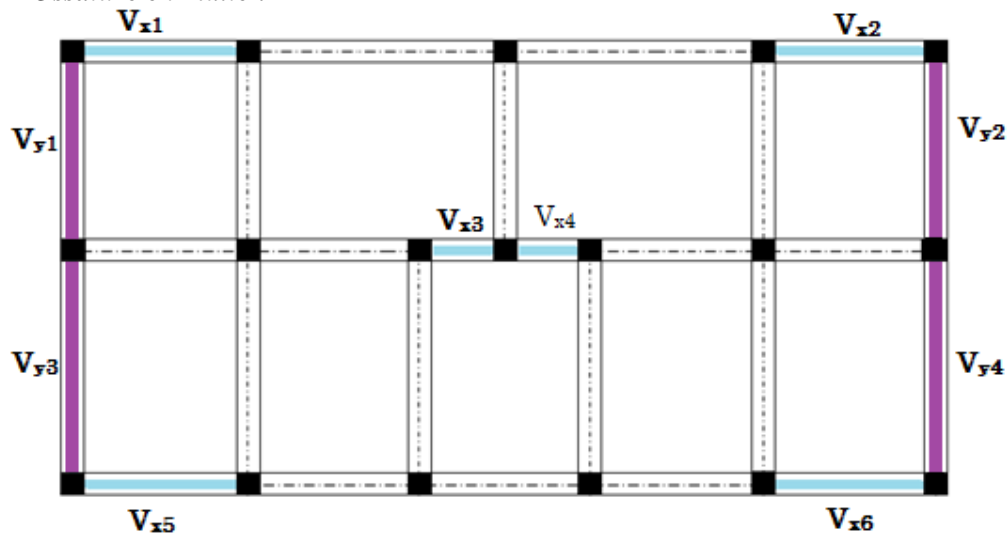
Disposition des contreventements pour l'ossature en mixte (acier-béton).
